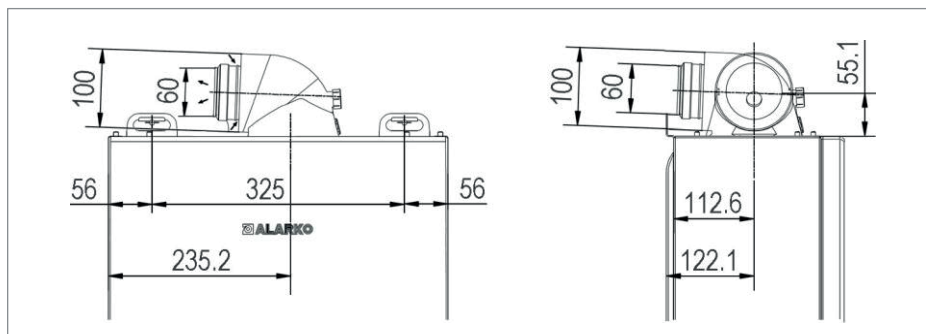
Dimensiuni set coș orizontal Ø60/100 mm
